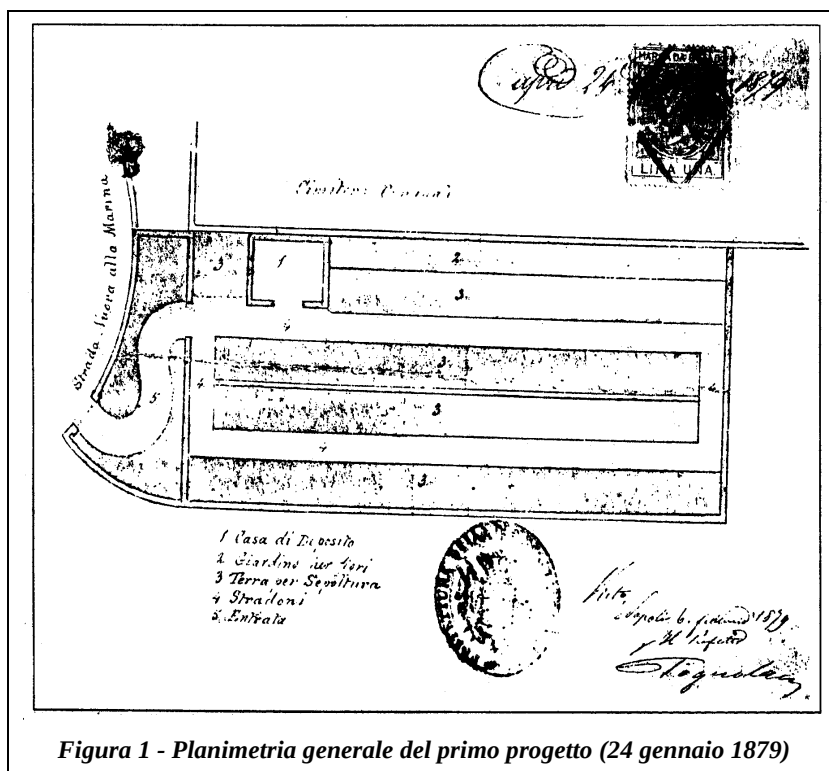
Planimetria generale del primo progetto (24 gennaio 1879)
